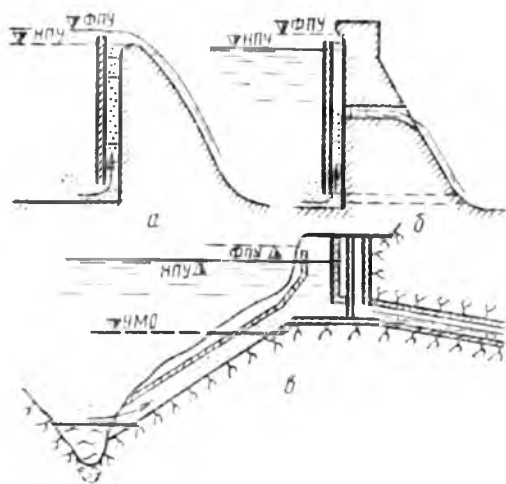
Схемы насосозахватных трактов (каналов) из водохранилищ и прудов для условий грунтовых и бетонных плотин:
